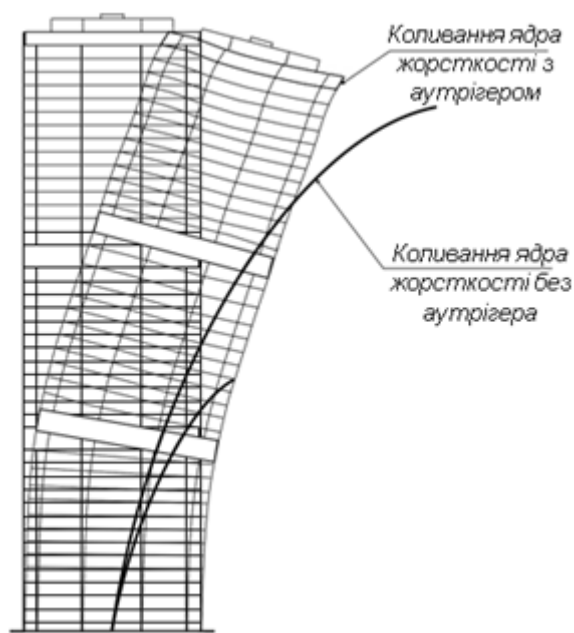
Порівняльна схема загальної жорсткості будівлі з аутрігерним поверхом та без нього
